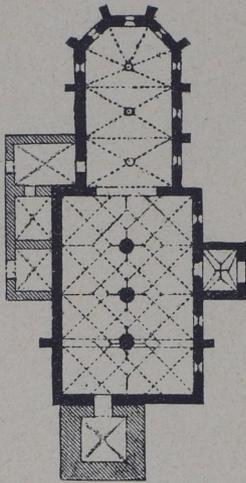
Grundriss der Decanalkirche in Kaplitz.
